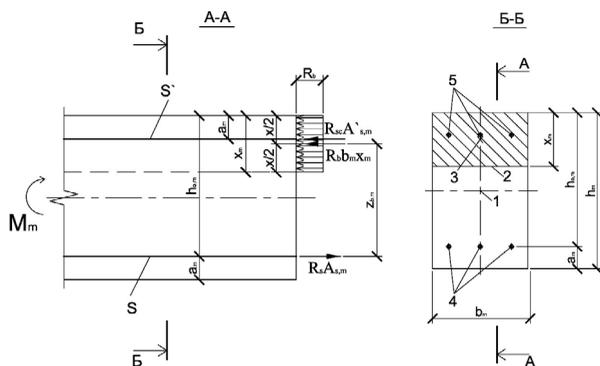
Схема к расчету модели железобетонной балки на прочность и деформации
